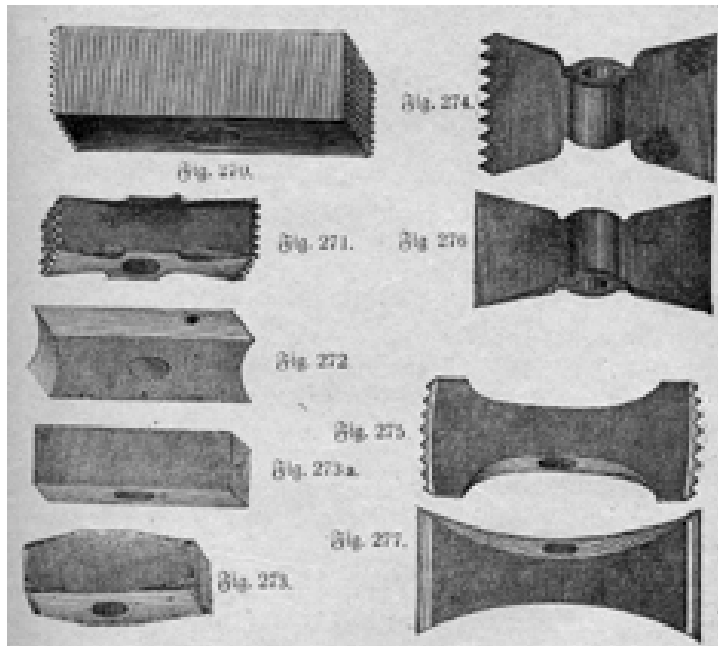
Werkzeuge zur steinmetzmäßigen Bearbeitung um 1905
